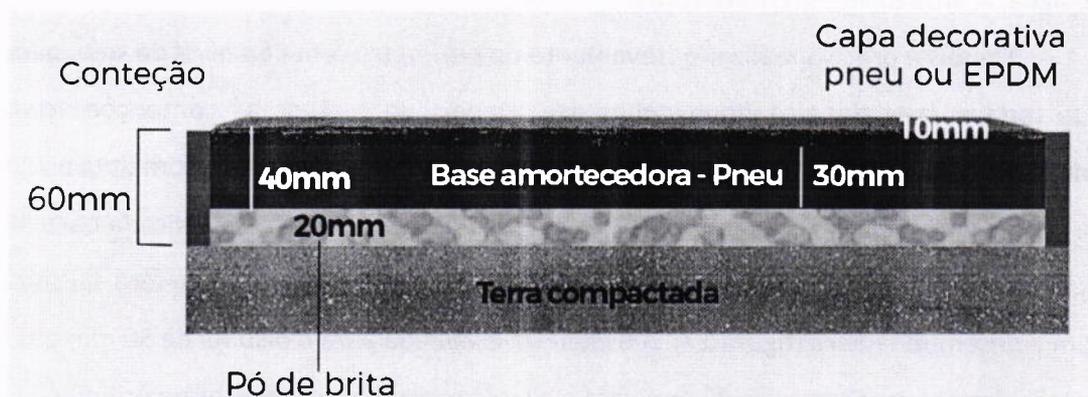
Camadas piso emborrachado monolítico. Fonte:
